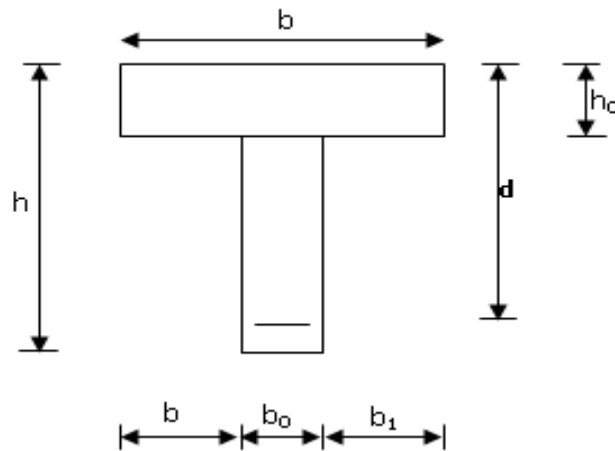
Section de calcul de la poutrelle après Coulage de la dalle de compression aux travées
